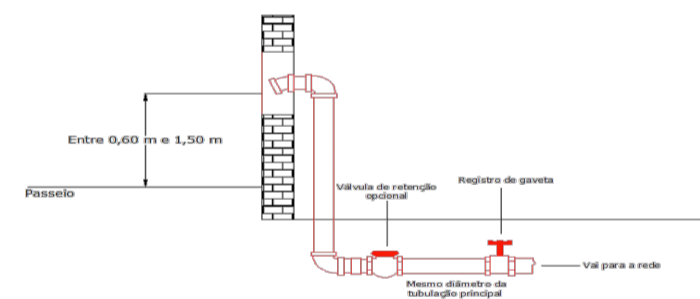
Hidrante de recalque na fachada ou muro da divisa
